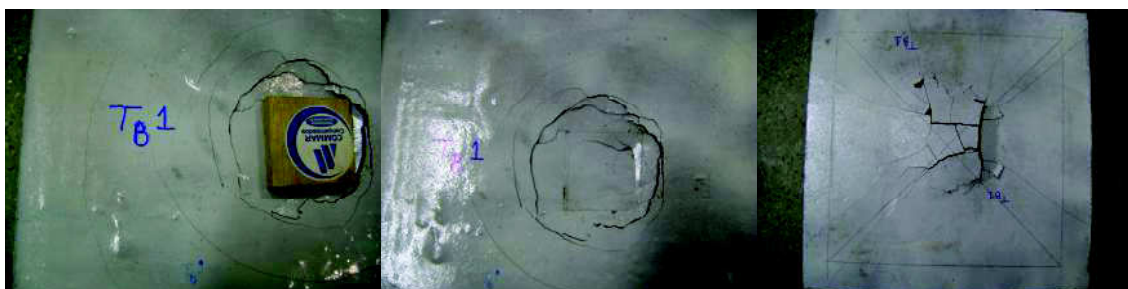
Detalhe das fissuras concêntricas nas partes superior e inferior da placa, após o término do ensaio.
